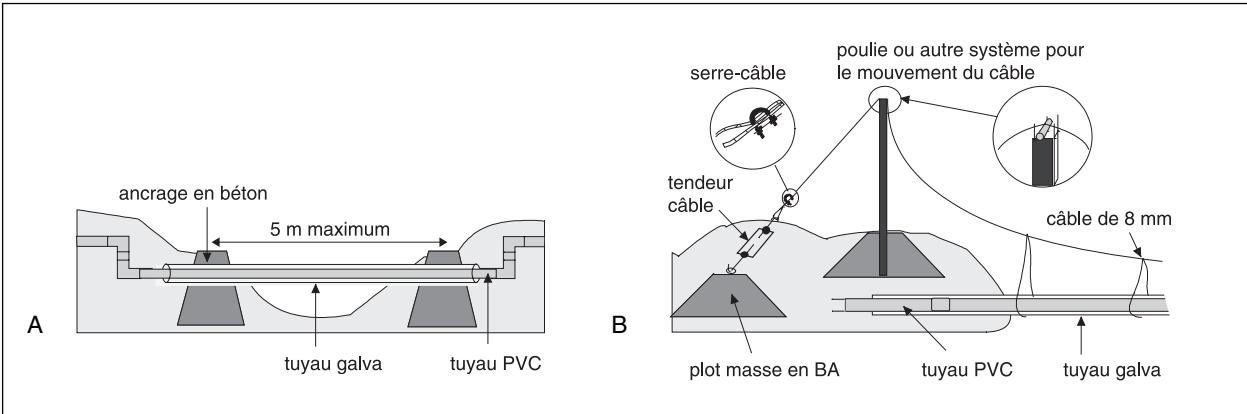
Passages de ravines ou rivières. A, utilisation d'un manchon en acier galvanisé. B, tuyau suspendu.
